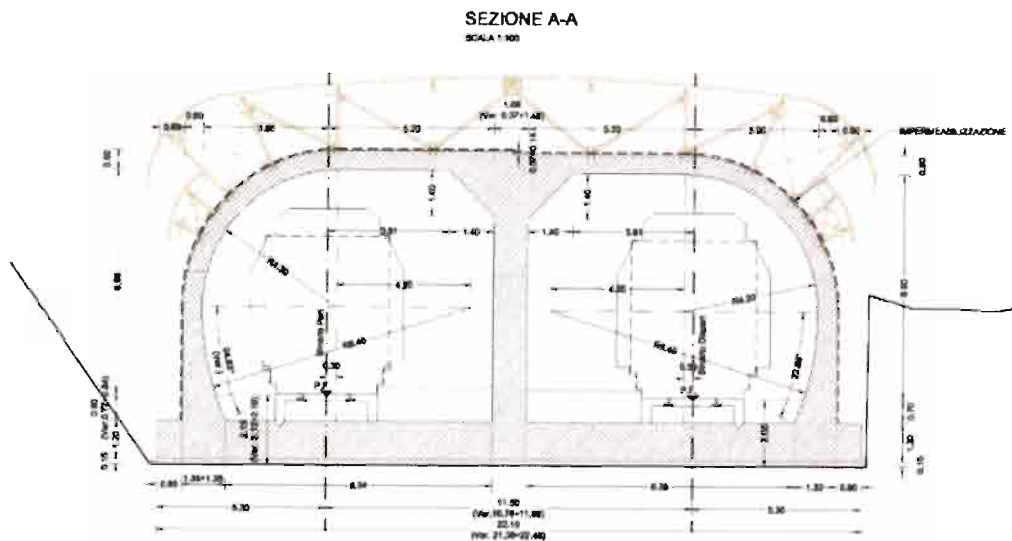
Fortezza: Sezione trasversale portale galleria Scaleres
